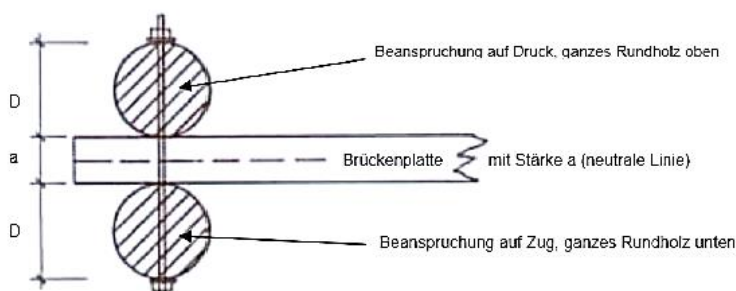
Section d'une poutre double mixte en bois rond (Source : SFN)
